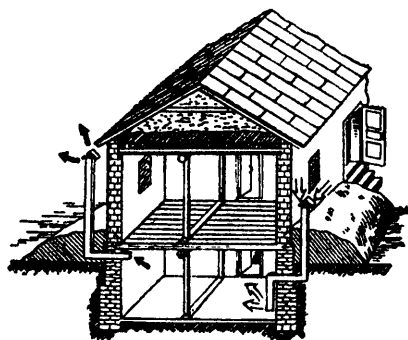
Противорадиационное укрытие с перекрытием из железобетонных плит:
